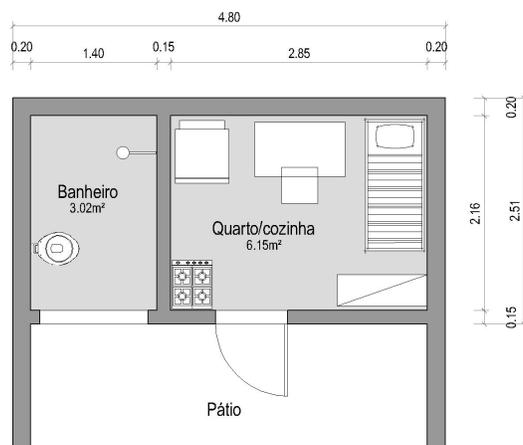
Planta Baixa da casa da Srª. Laisir, com apenas 9m².
